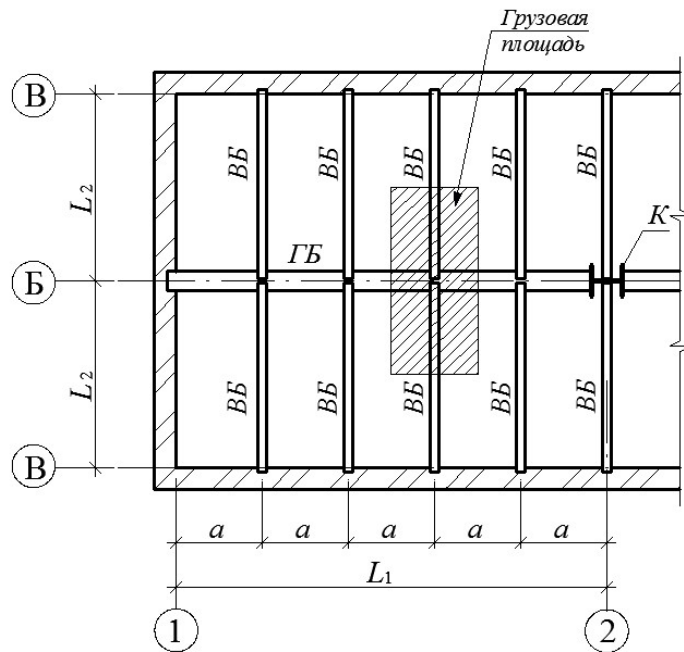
Схема для определения грузовой площади на один узел главной балки
